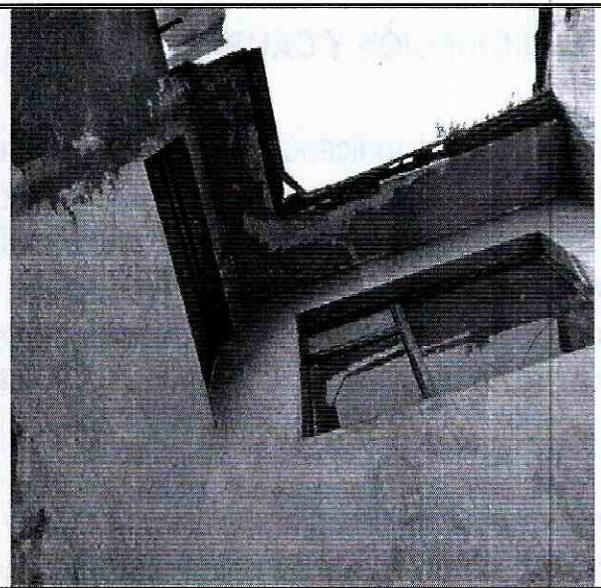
Vista de las humedades y fisuras en muros
